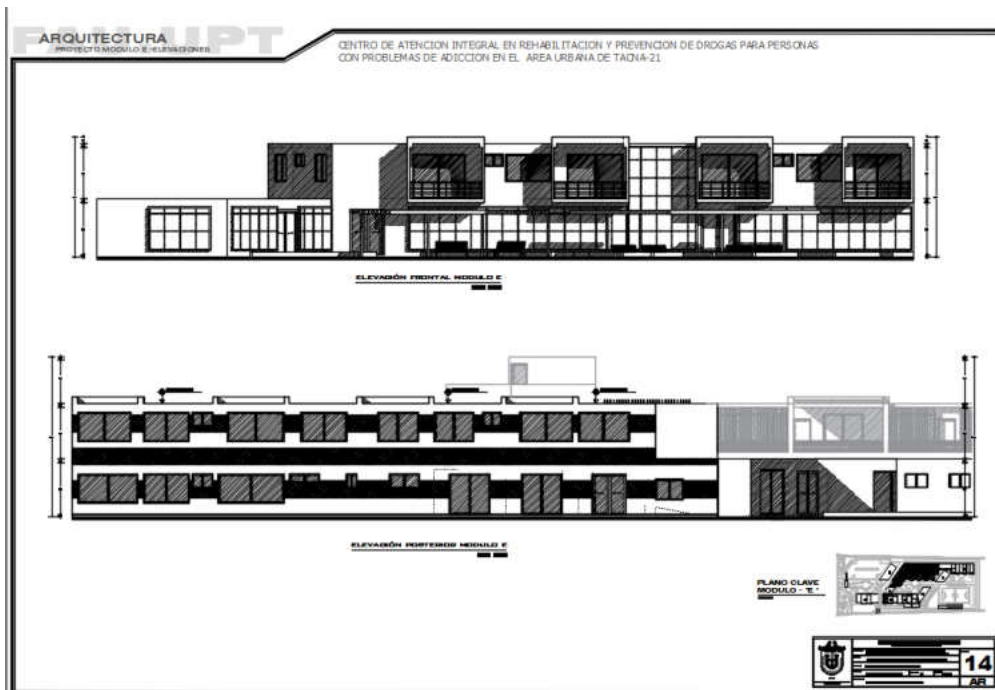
Plano elevaciones bloque E, fuente elaboración propia.
